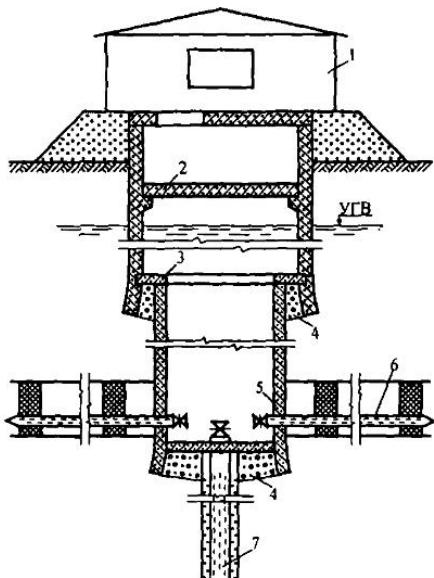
Конструкция лучевого водозабора: 1 – наземный павильон управления; 2 – перекрытие; 3 – железобетонная плита; 4 – бетонное днище; 5 – задвижка; 6 – скважина горизонтального бурения; 7 – вертикальная скважина, оборудованная обсыпным фильтром
